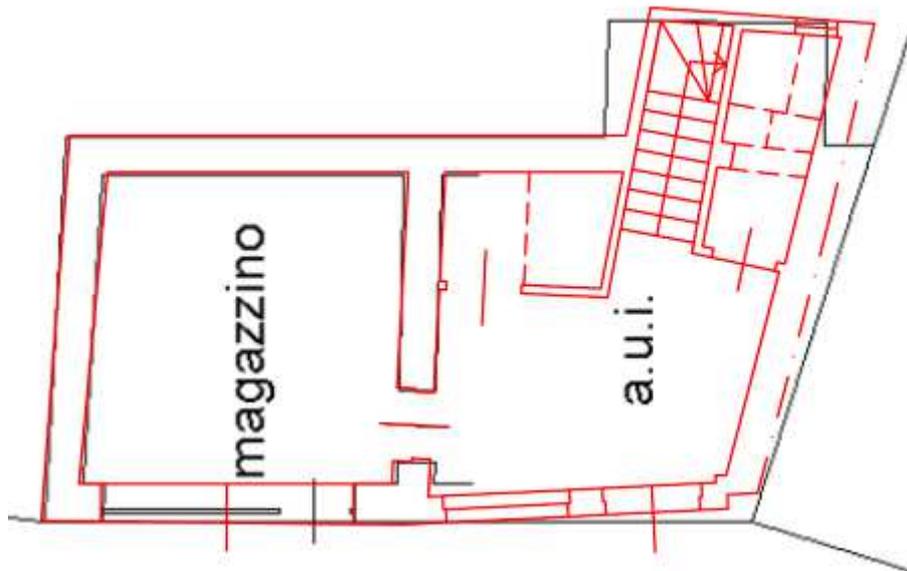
Sovrapposizione tra lo stato attuale - planimetria catastale, sub. 3 (p.t.).
